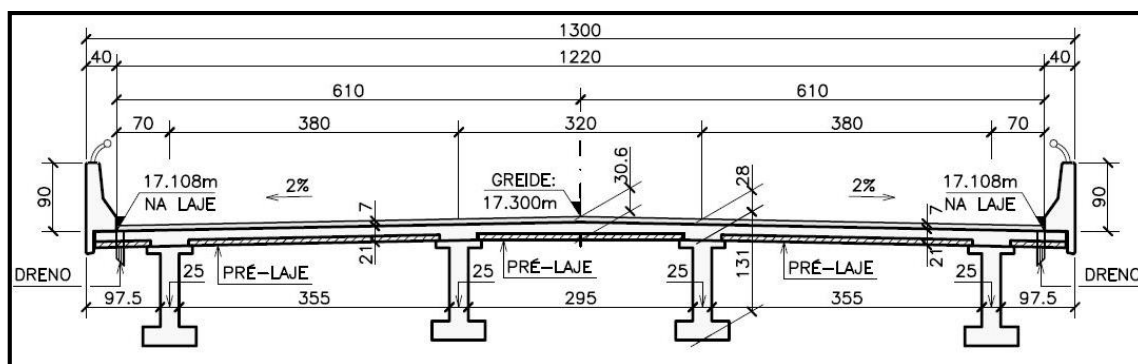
Ponte sobre o Arroio Lagoões – Seção Transversal Tipo.
